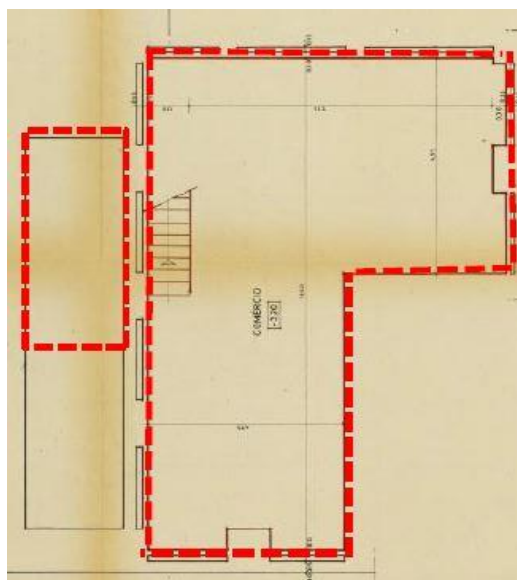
Planta de alteração da cave, arquivo municipal (1978)
